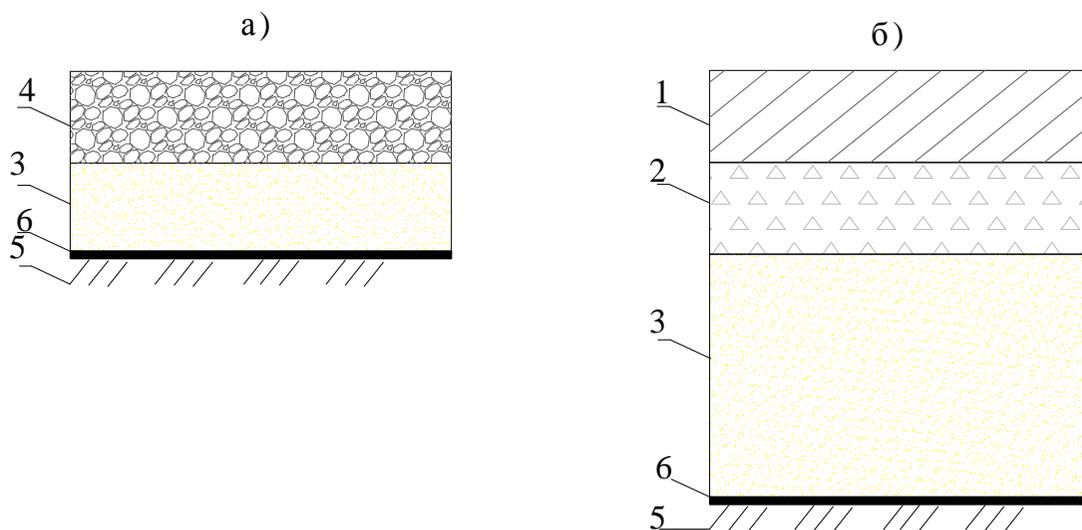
Конструкции дорожных одежд с геотекстилем Тайпар для переувлажненных грунтов:
